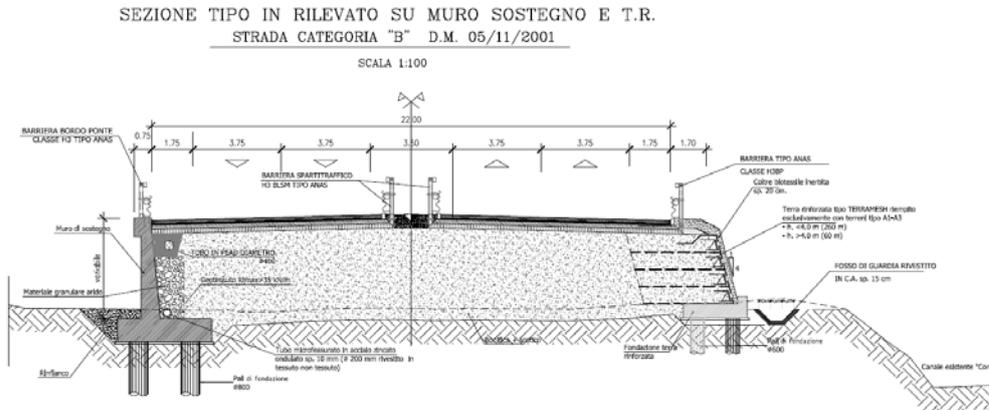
Sezione tipo rilevato d'approccio al VI01 (PD)
